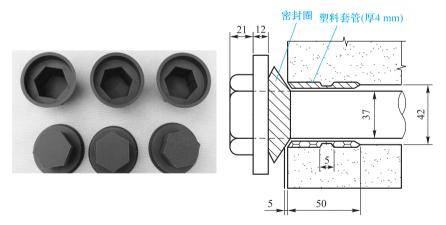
螺栓孔和压浆孔防水(尺寸单位:mm)
